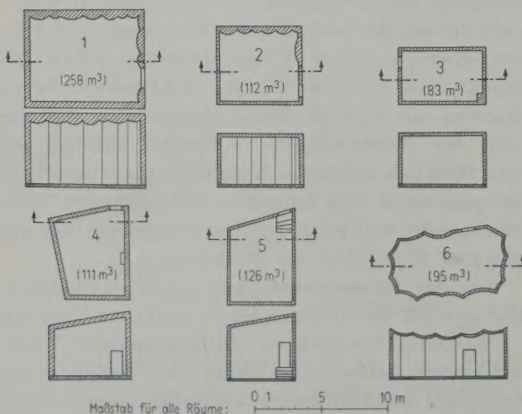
Grundrisse und Schnitte der untersuchten Hallräume.
